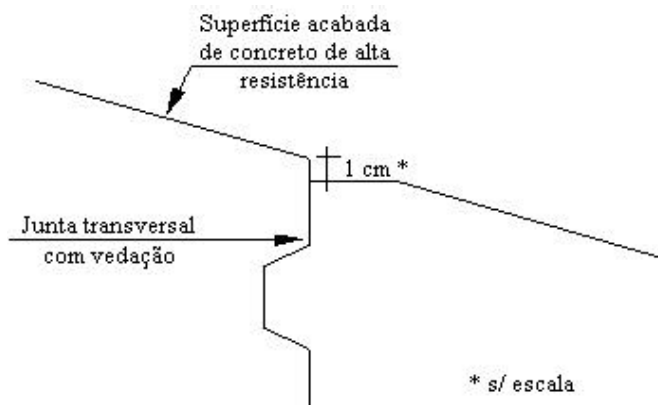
detalhe do rebaixamento na justaposição entre lajes – juntas de dilatação (LEITE; ABBUD, 1996)
